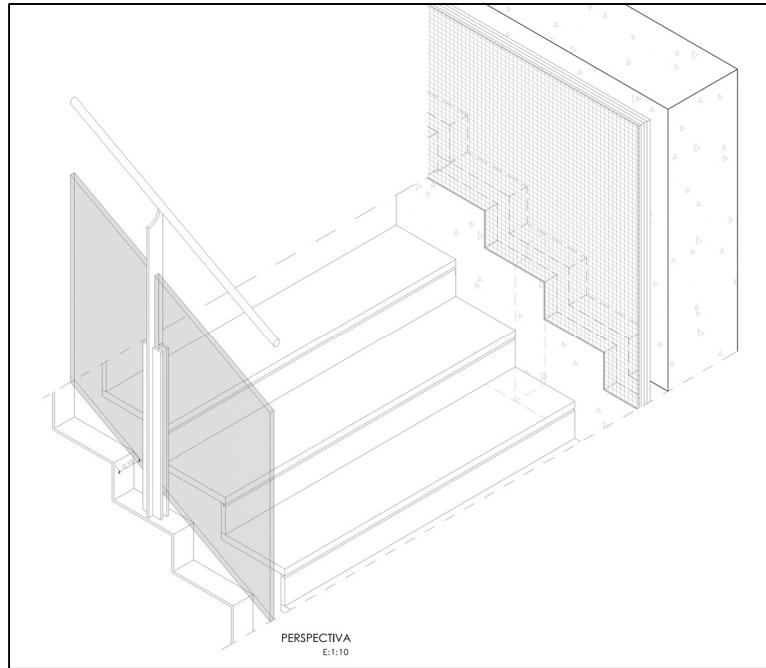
Plano de Carpintería 1070E-O13(m1).
